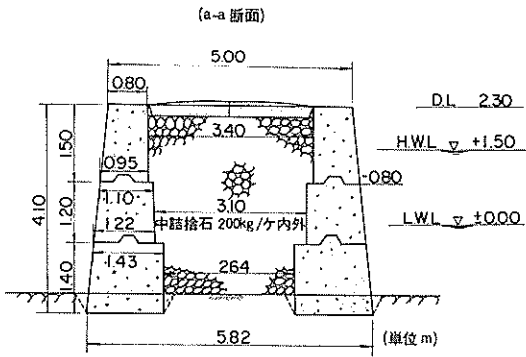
雄勝港立浜防波堤 (A) 標準断面図
